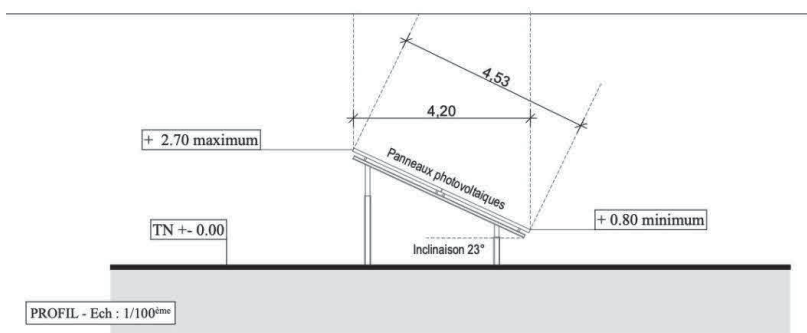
Coupe transversale des tables de panneaux photovoltaïques
